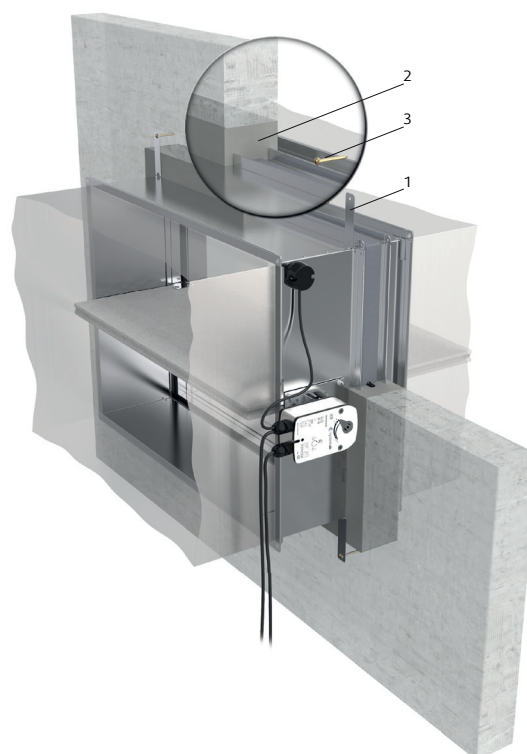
Våt installation brand-/ brandgasspjäll PKIS med en blandning av gips och murbruk eller betong
